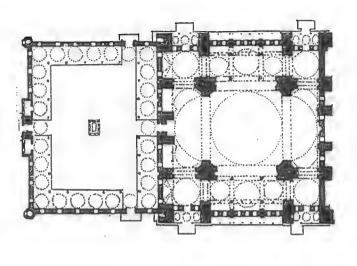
المسقط الأفقي للجامع الأخضر في بورصه . (عن Aslanapa) (عن ٢٨١
